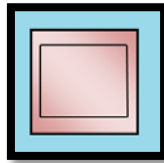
Planta de la torre de La Rijana. Sin escala. Elaboración propia.
